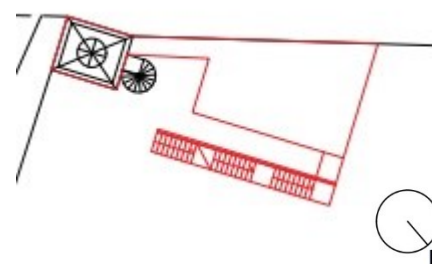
Planta de Construção e Demolição, Bar, autoria própria
